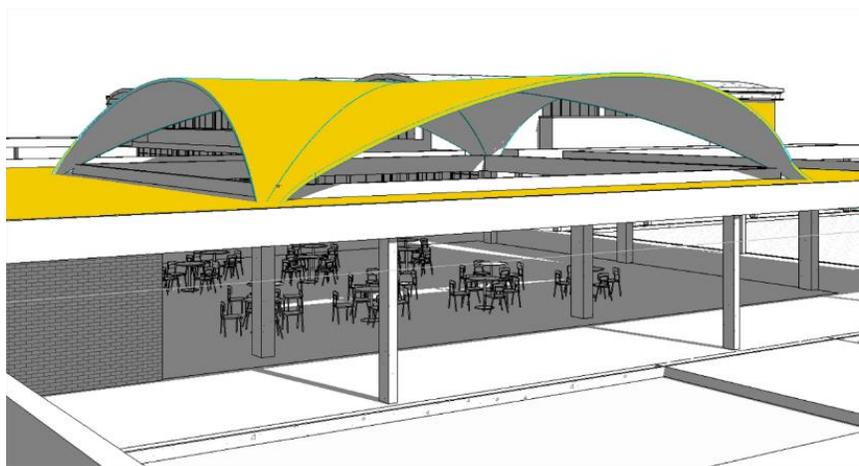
Cubierta Laminar Cafetería. Modelado BIM.
